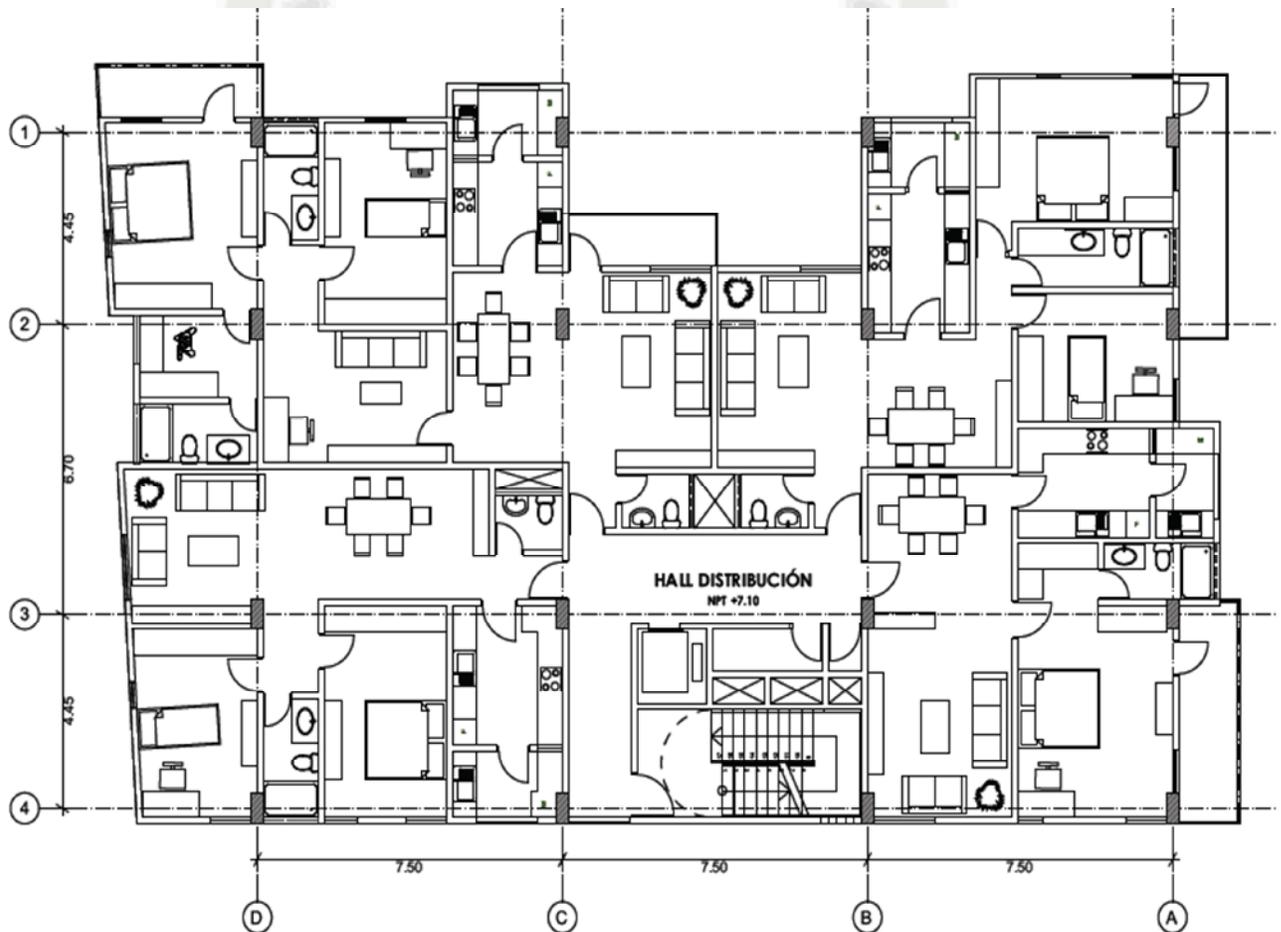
Arquitectura Inicial del 3ro, 5to, 7mo, 9no Piso.
